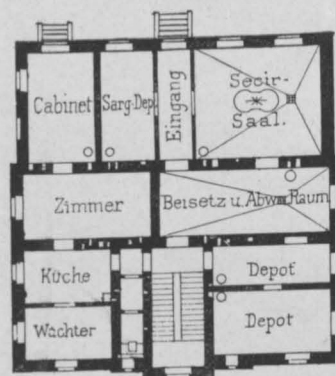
Ebenerd-Grundriss des Hauptgebäudes.
